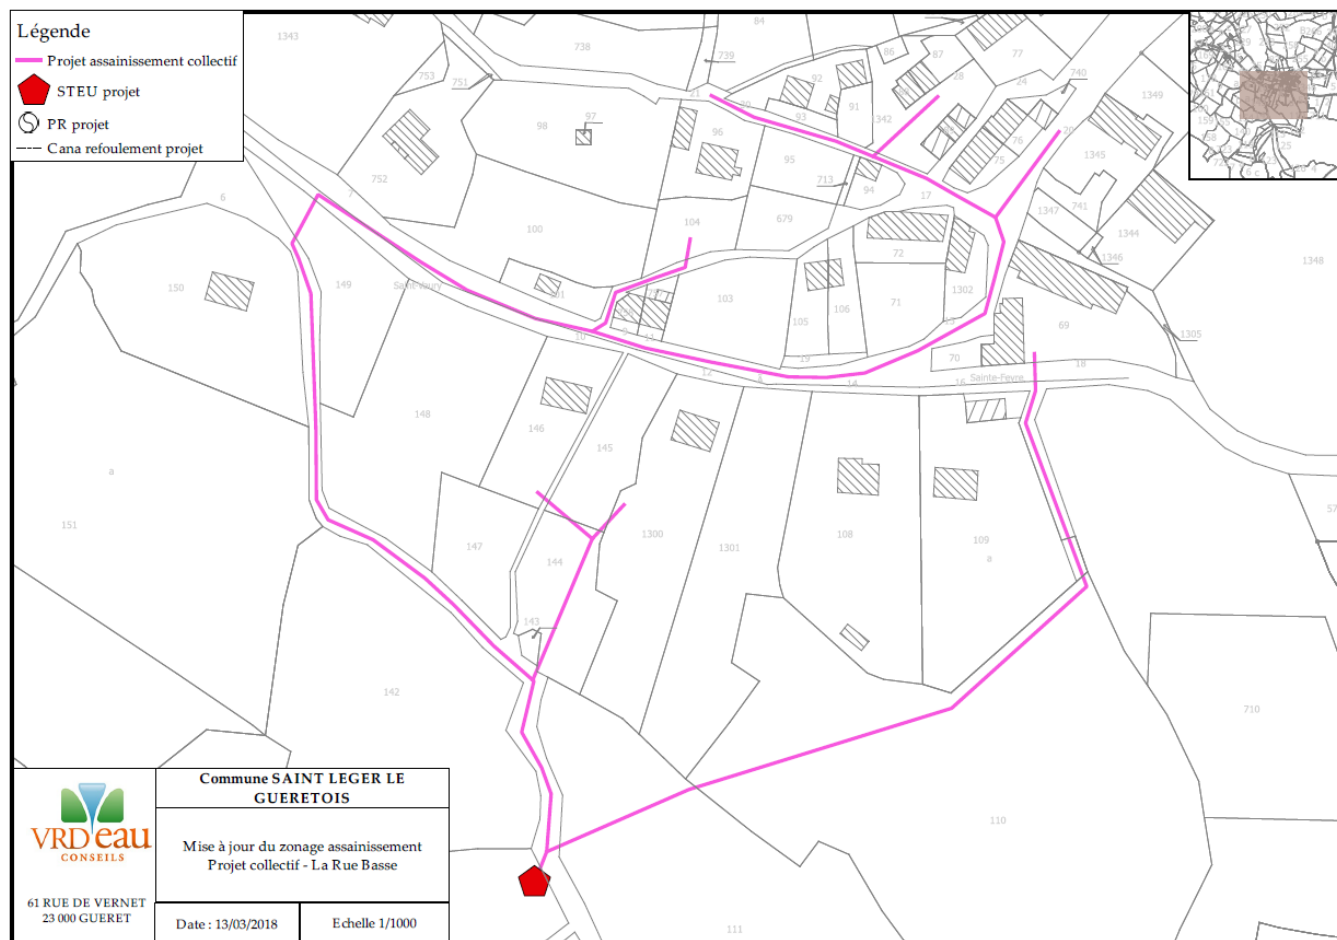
projet d'assainissement collectif sur le village de la Rue Basse
